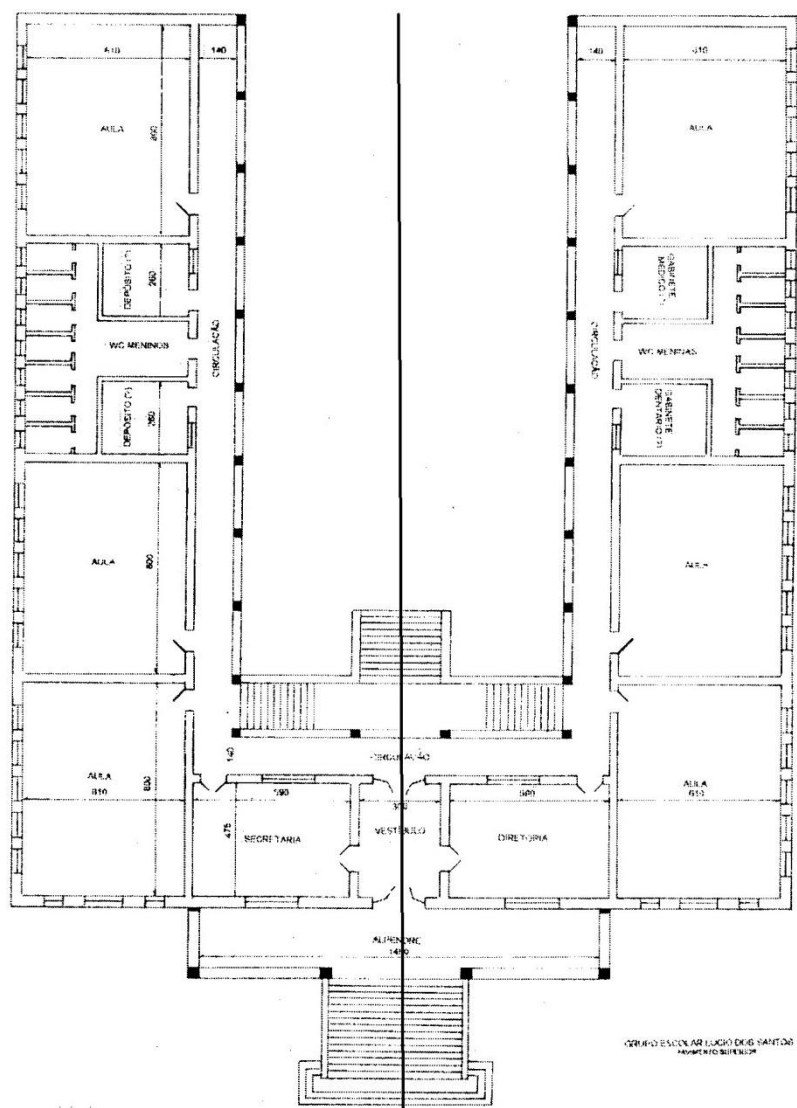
Planta do pavimento superior do Grupo Escolar Lúcio dos Santos
